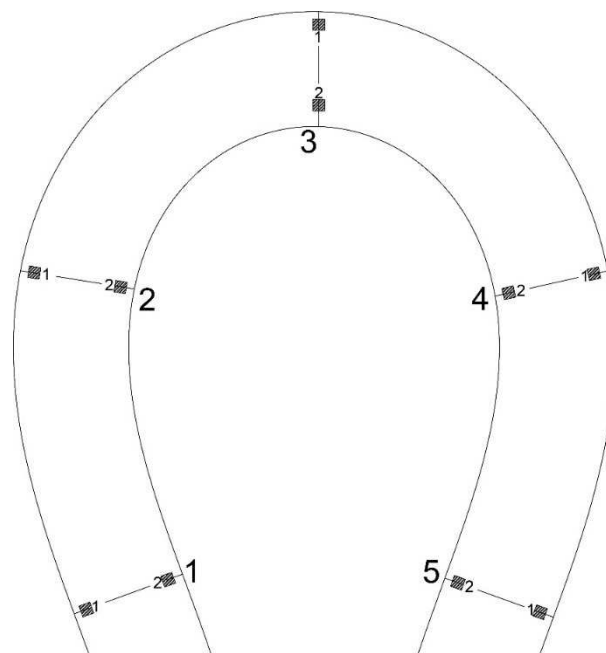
Planimetria con posizionamento delle zolle estratte
